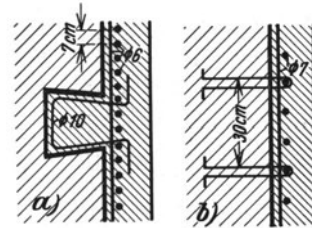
Verankerung der Eisenbetondichtungswand an der Innenseite der bestehenden Wand. a) nach A. A. Boon, mit schwalbenschwanzförmigen Tragbalken, b) mit Bügeln, alle 30 cm nebeneinander.
